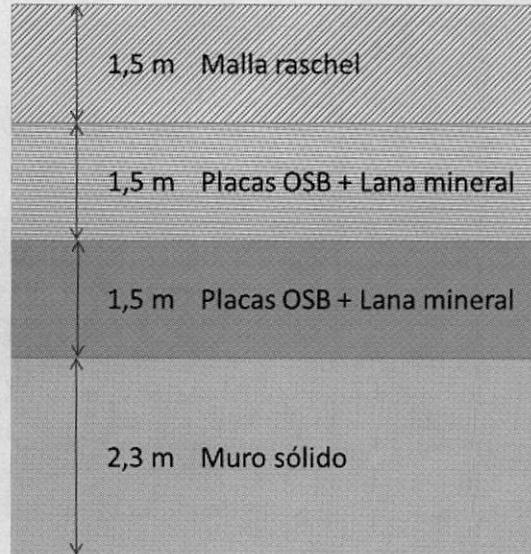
Cierre perimetral propuesto para costado oriente del proyecto.
